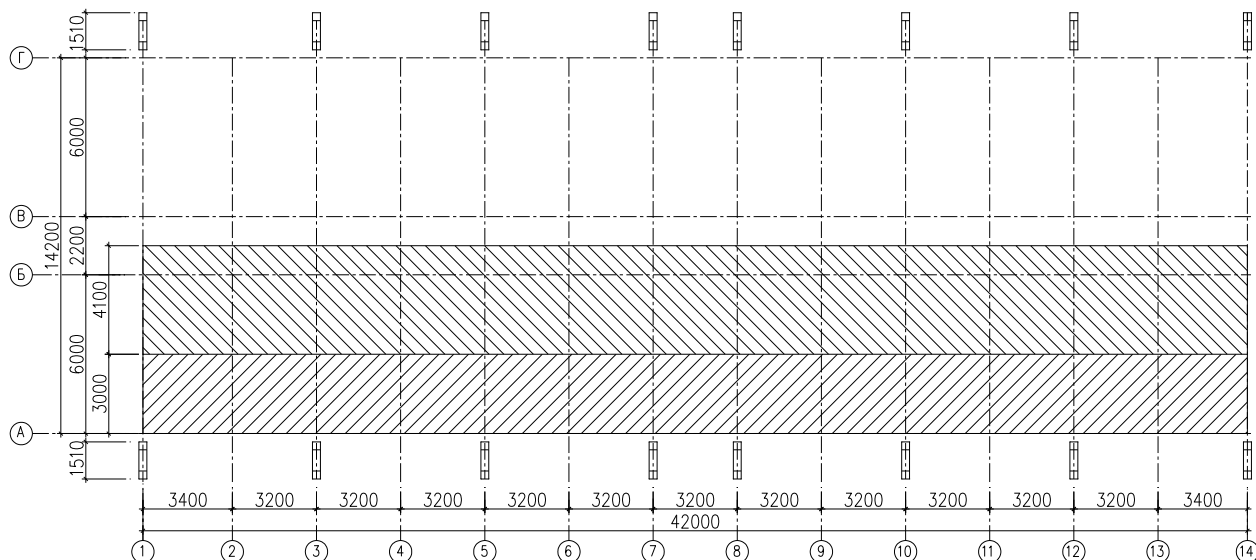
Грузовые площади для стен крайнего и среднего ряда 1-4 этажей
